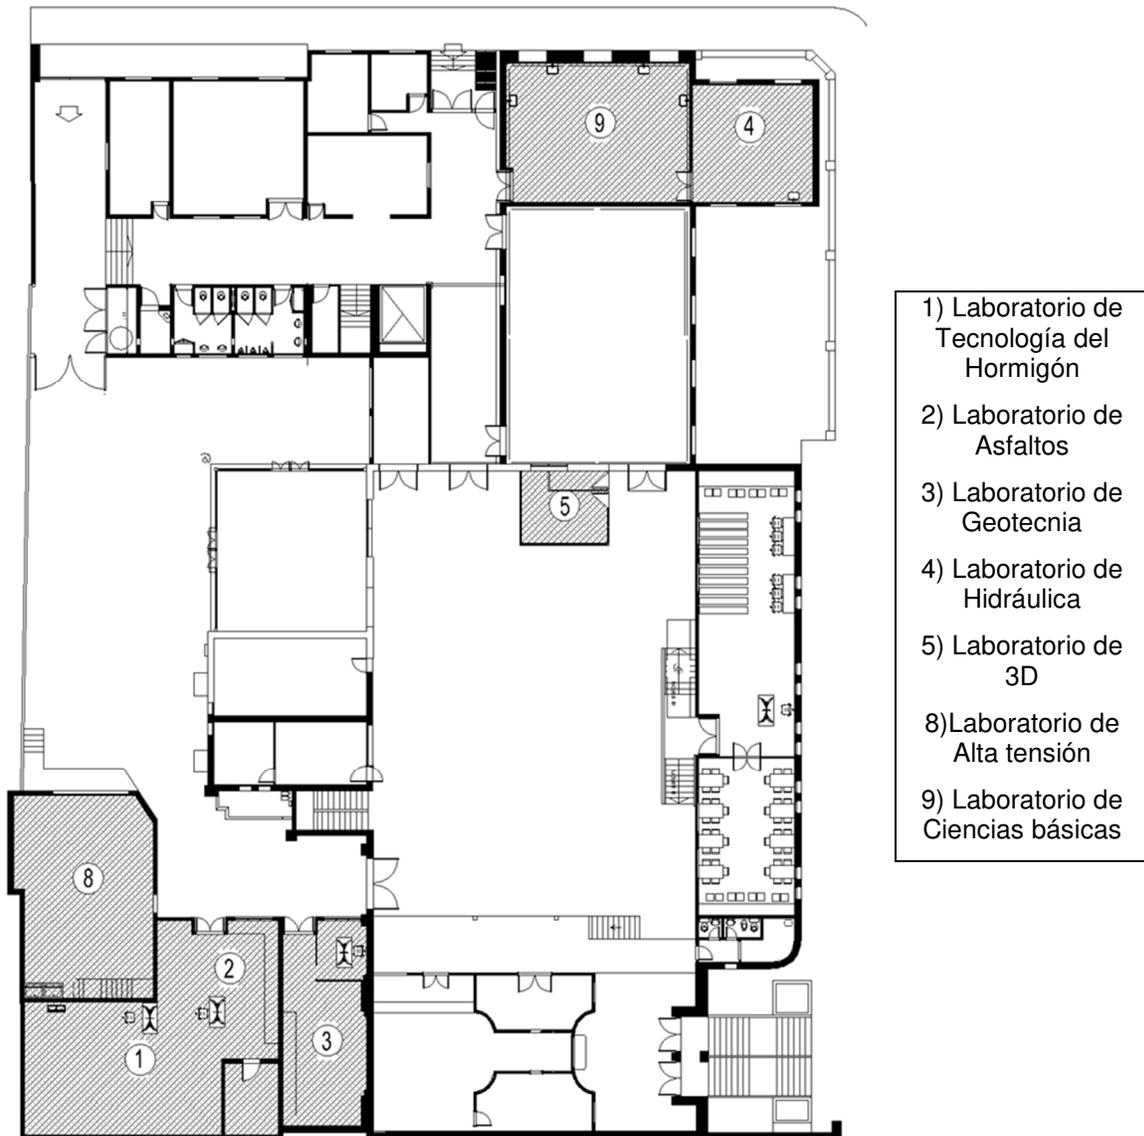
Croquis con ubicación de los laboratorios en Planta Baja. (FRCon)
